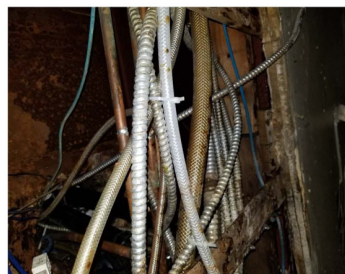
Endommagement de la structure du plancher du rez-de-chaussée
